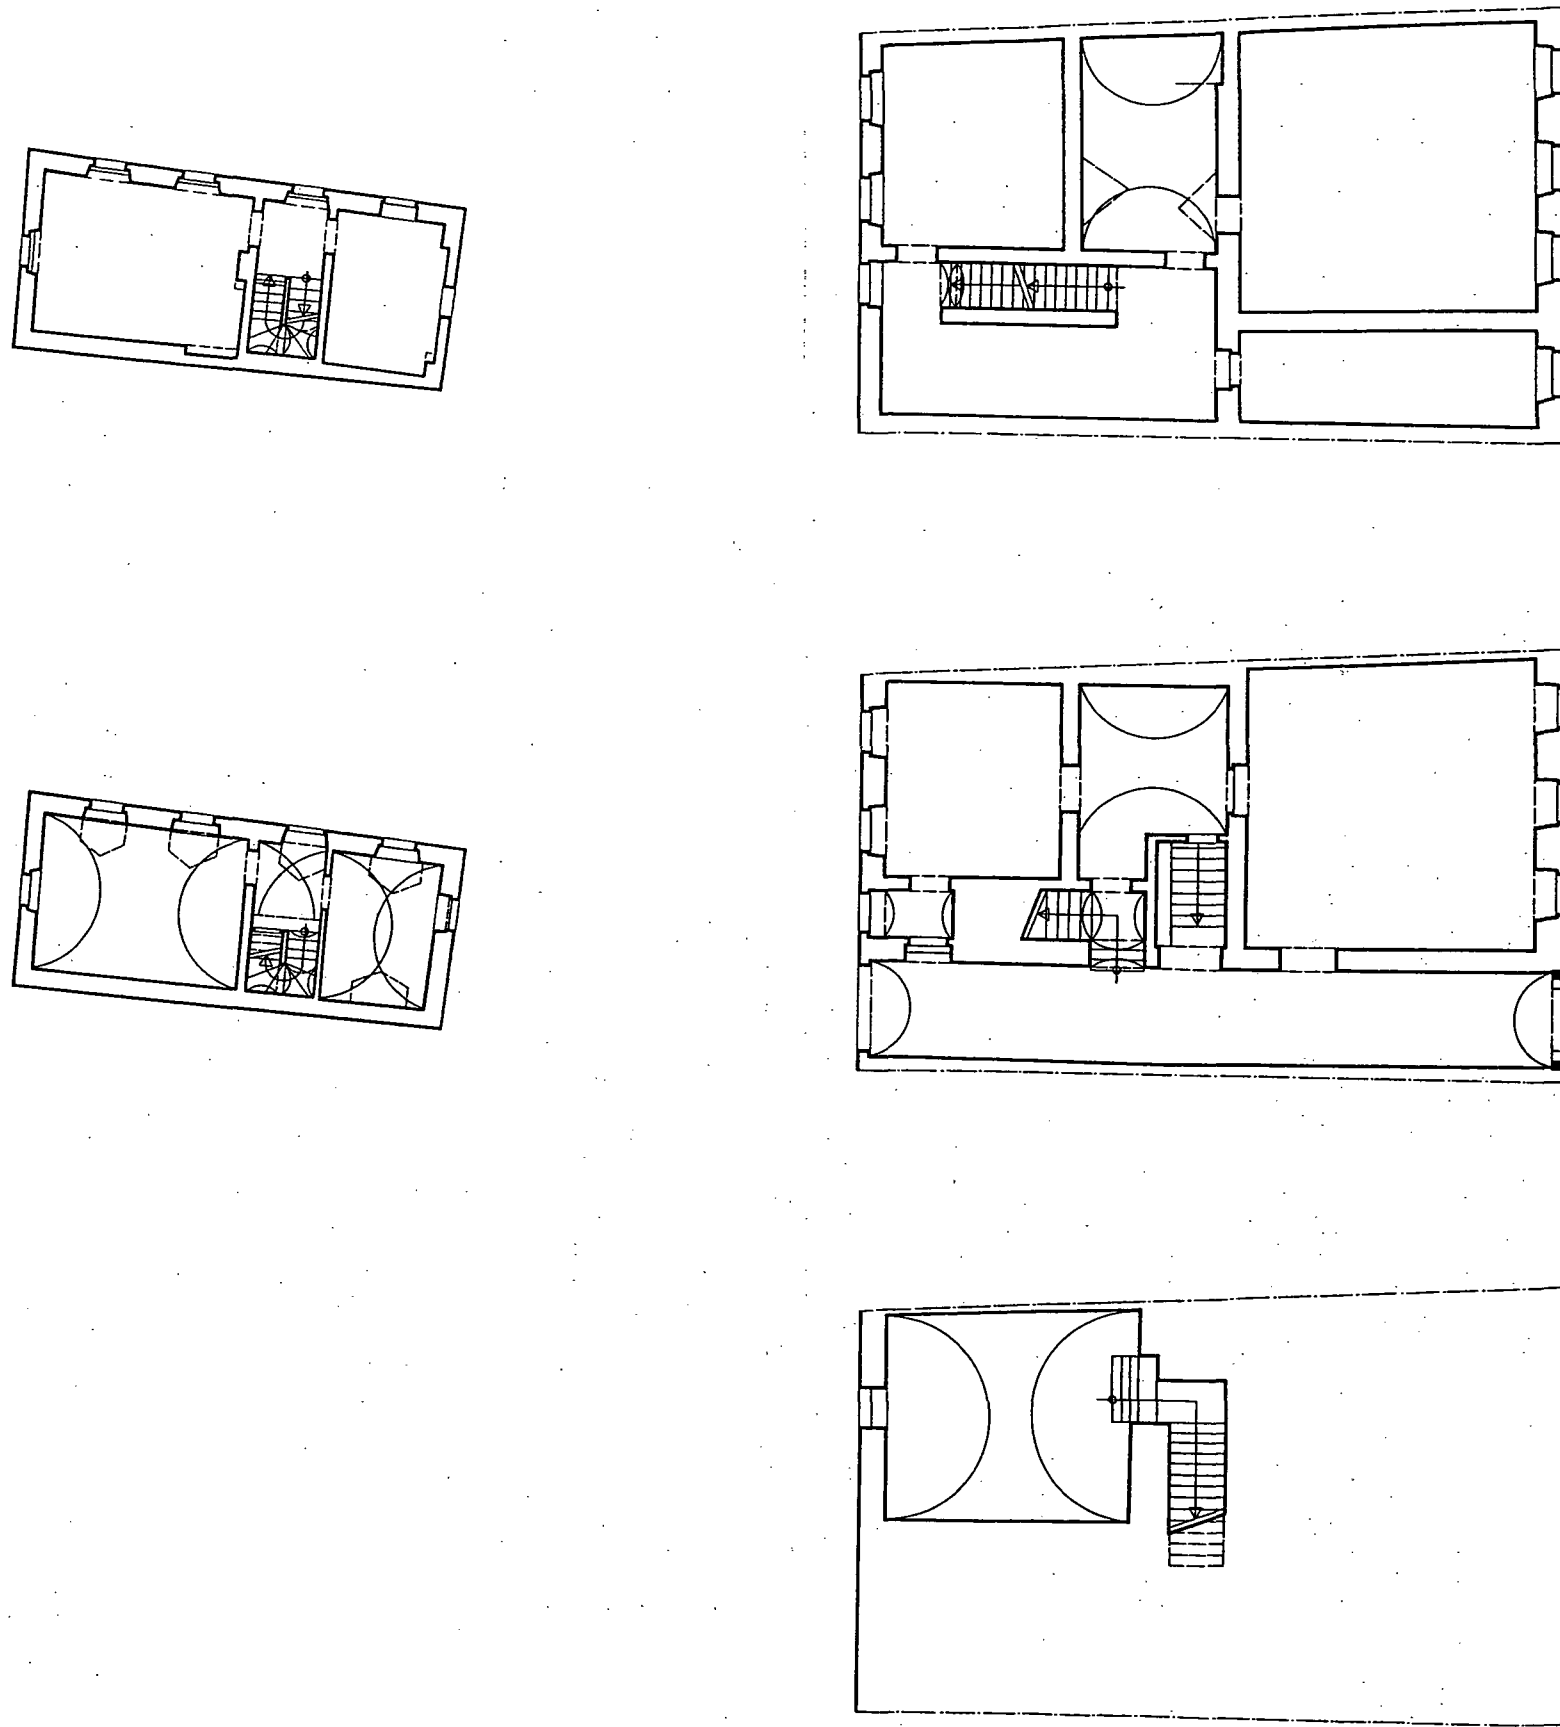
Stadtplatz 36, 38 – Grundrisse Keller, Erdgeschoss, Obergeschoss (1:200).
